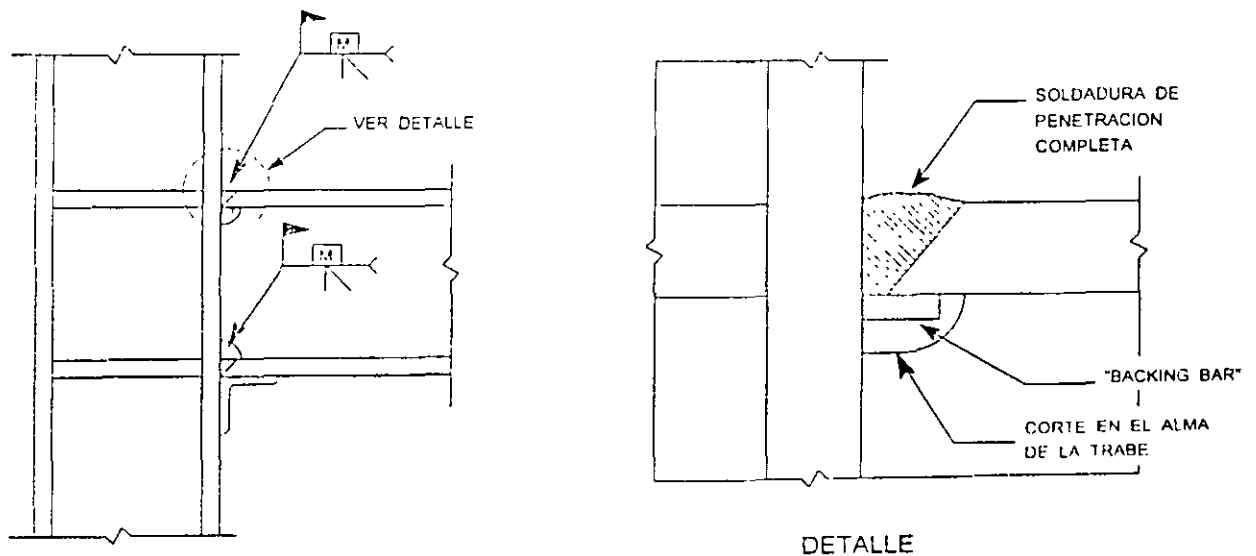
Detalle de colocación de la placa de respaldo de las soldaduras de penetración completa
